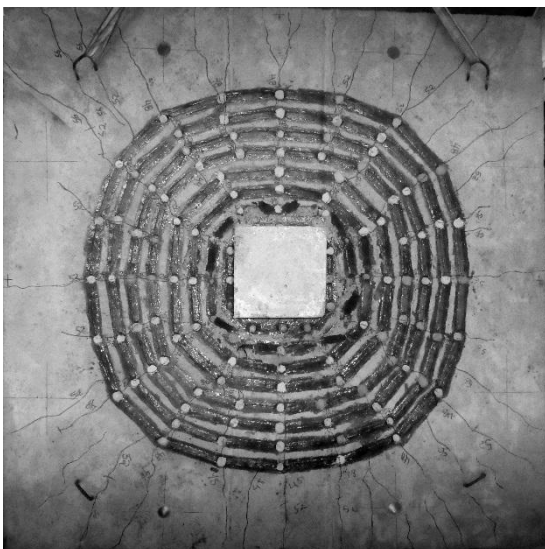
Padrão de Fissuração - LR-S2-8
